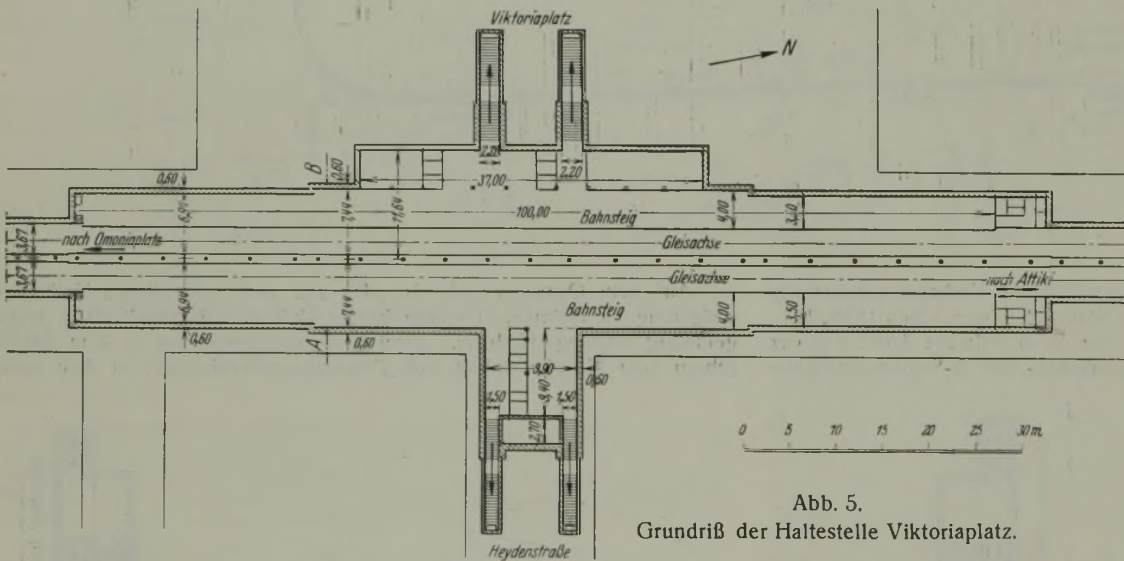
Grundriß der Haltestelle Viktoriaplatz.
